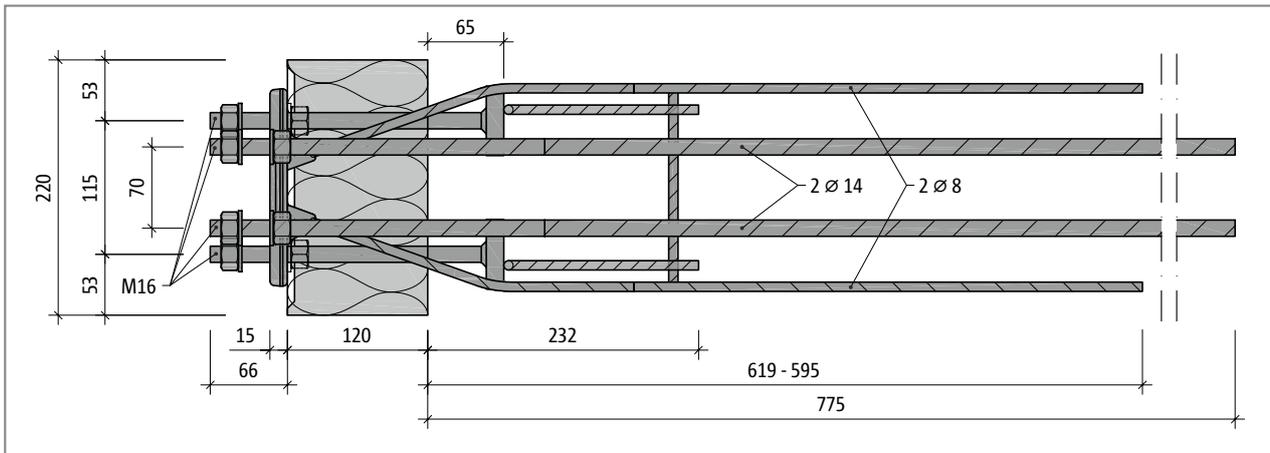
Schöck Isokorb® XT Typ SK-M1-V1: Grundriss
